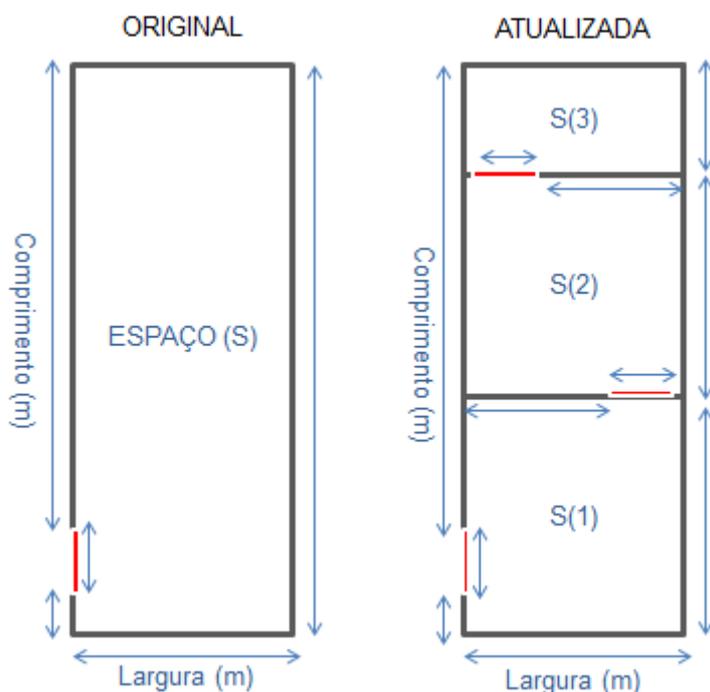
EXEMPLO DE ATUALIZAÇÃO DA PLANTA ARQUITETÔNICA
